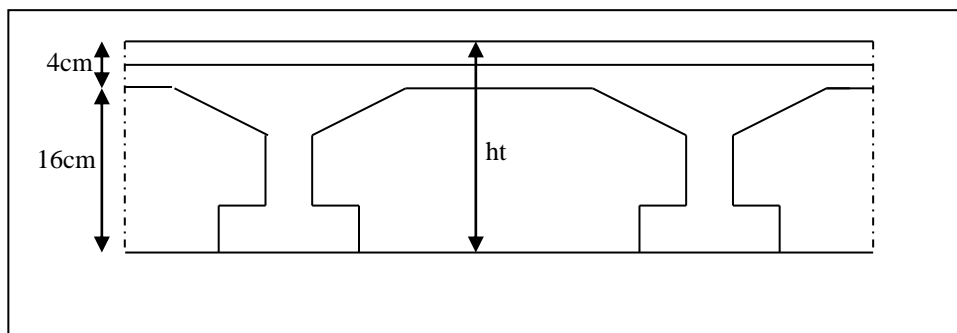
« Coupe transversale d'un plancher à corps creux »
